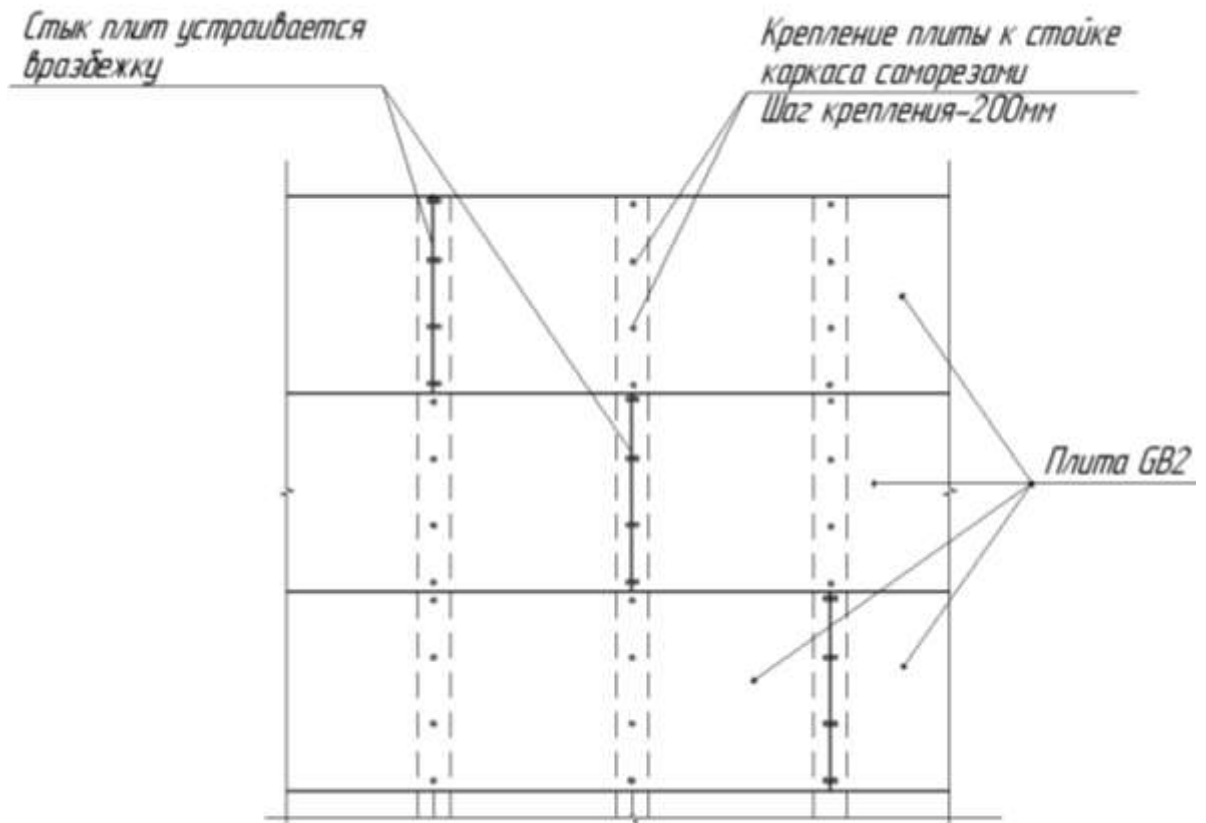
Общий вид наружной стороны деревянной стены, со смонтированной несъёмной опалубкой
